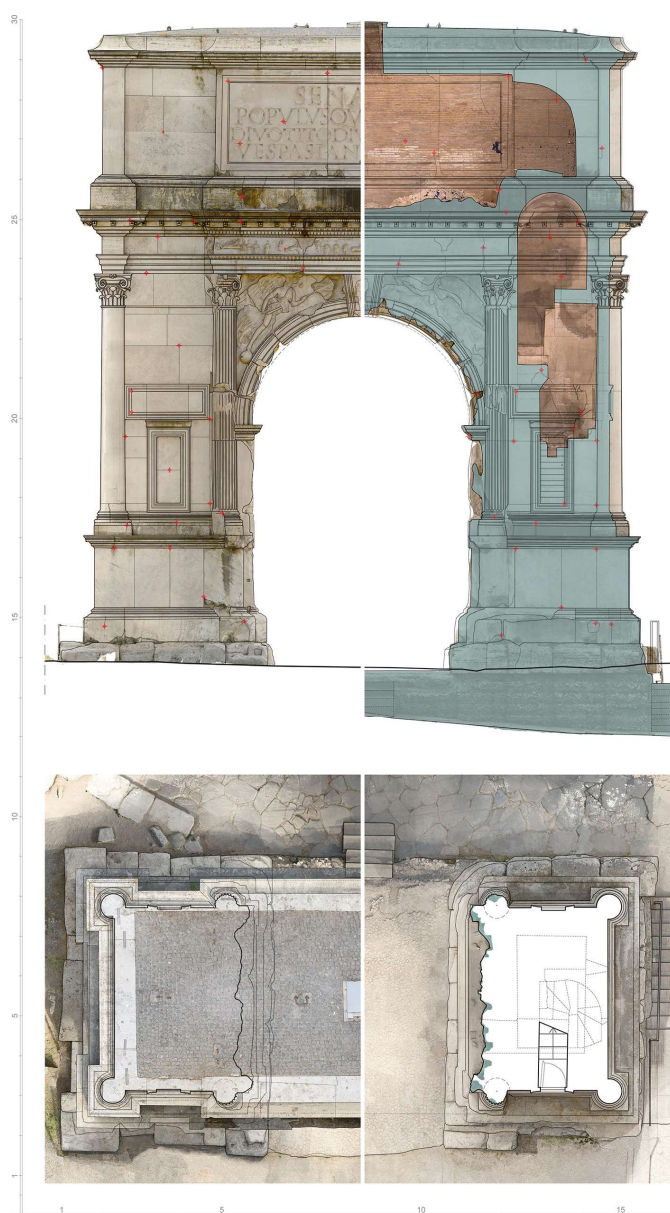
Representación del levantamiento integrado del Arco de Tito. Planta de la cobertura y sección horizontal, fachada sureste y sección longitudinal con ortofoto.
